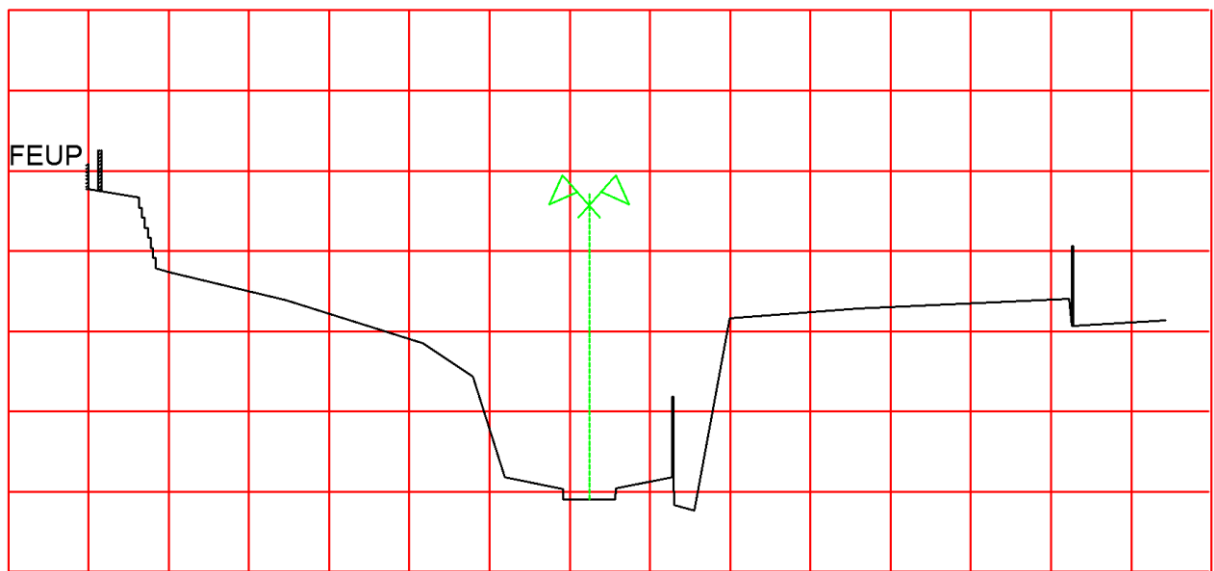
2 – Perfil transversal da linha de implantação da ponte (cada espaçamento horizontal e vertical corresponde a 10 m e 1 m respetivamente)
